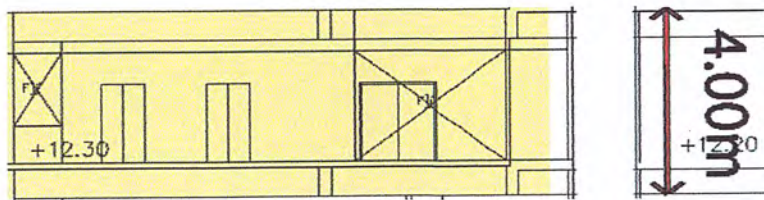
แสดงผังและ Plan ส่วนโถงลิฟท์ - โถงทาง
